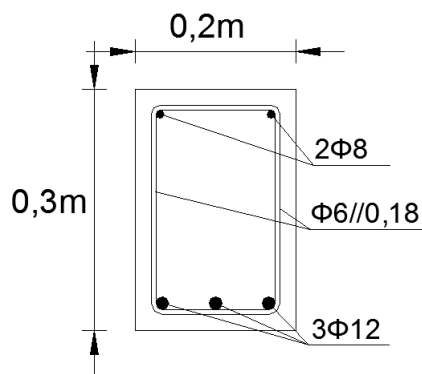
Secção transversal das Vigas 4, 5 e 6.
